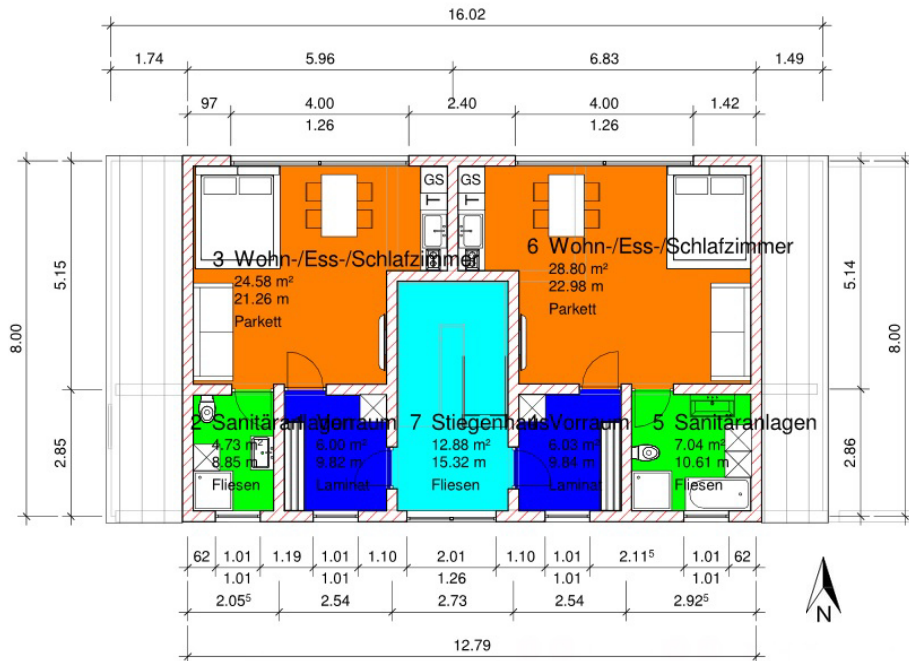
Geschoßaufstockung - Grundriss DG
